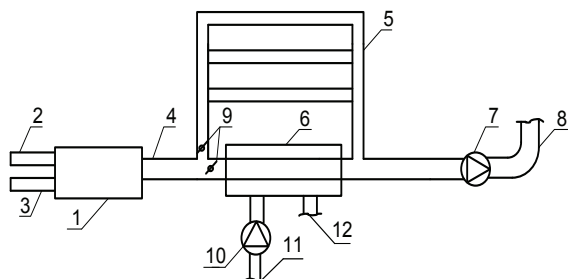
Принципиальная схема системы теплоснабжения: 1 – газовая горелка; 2,3 – патрубки подачи горючего газа и воздуха; 4 – начальный участок трубчатого нагревателя; 5 – воздушный трубчатый нагреватель; 6 – водяной трубчатый нагреватель; 7 – вытяжной вентилятор; 8 – патрубок удаления отработанных продуктов сгорания; 9 – поворотные заслонки; 10 – водяной насос; 11,12 – патрубки присоединения водяной системы к нагревателю
